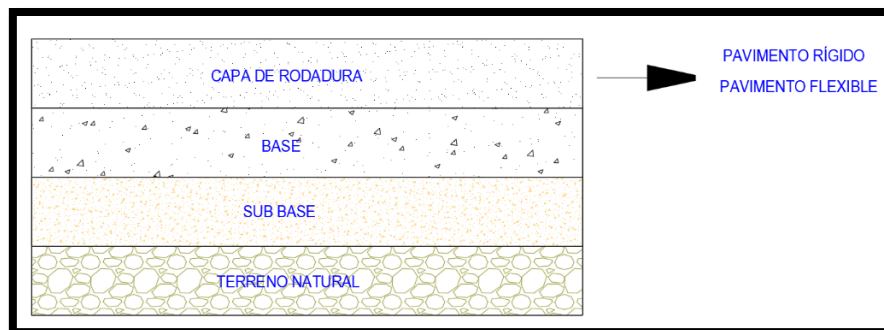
Elaboración Propia de la Estructura de Pavimento.
